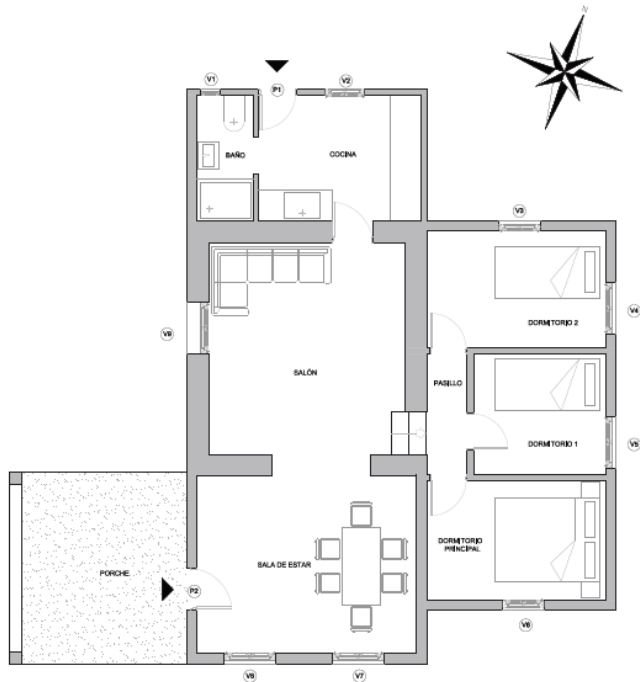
Planta del estado actual de la vivienda. Fuente: Elaboración propia
